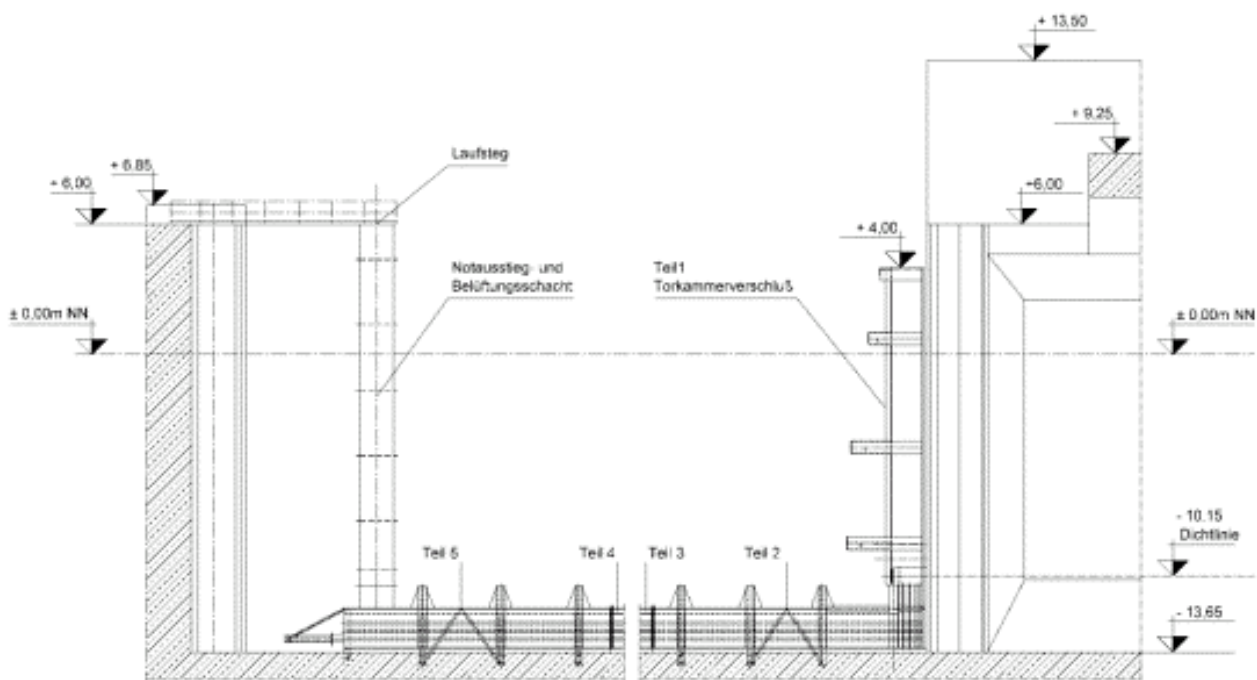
Schleusenkammerquerschnitt mit gesetzten Tunnelsegmenten
